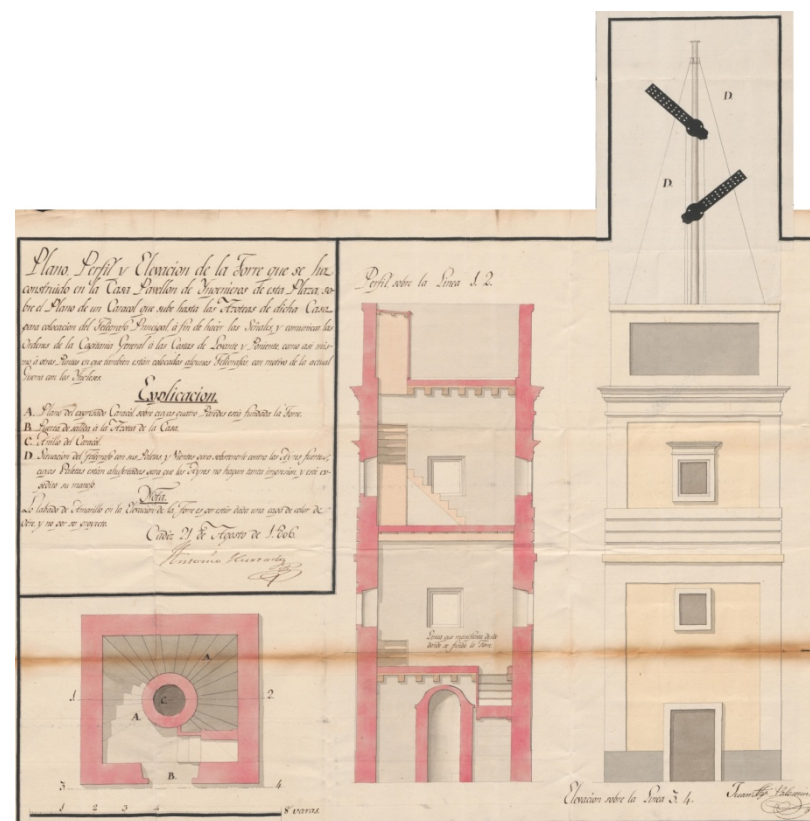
Plano de la torre construida en la casa pabellón de Ingenieros de Cádiz. Antonio Hurtado.
